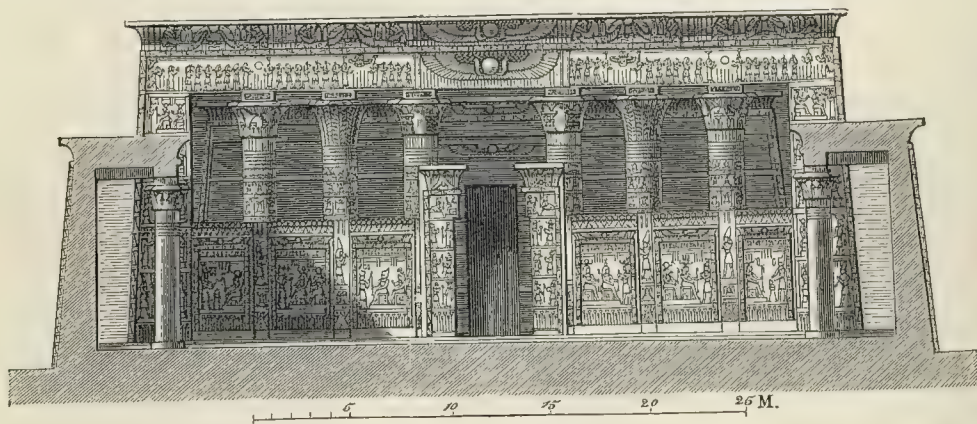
Храмъ въ Эдфу. Передній фасадъ колоннады.
